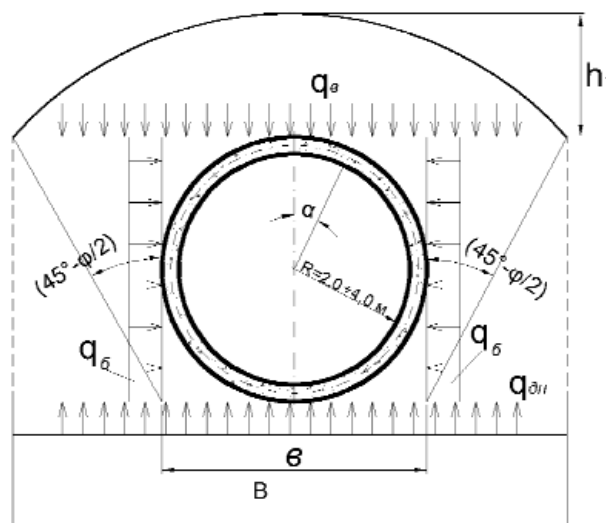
Расчетная схема монолитных подземных сооружений кольцевого сечения в неустойчивых породах
